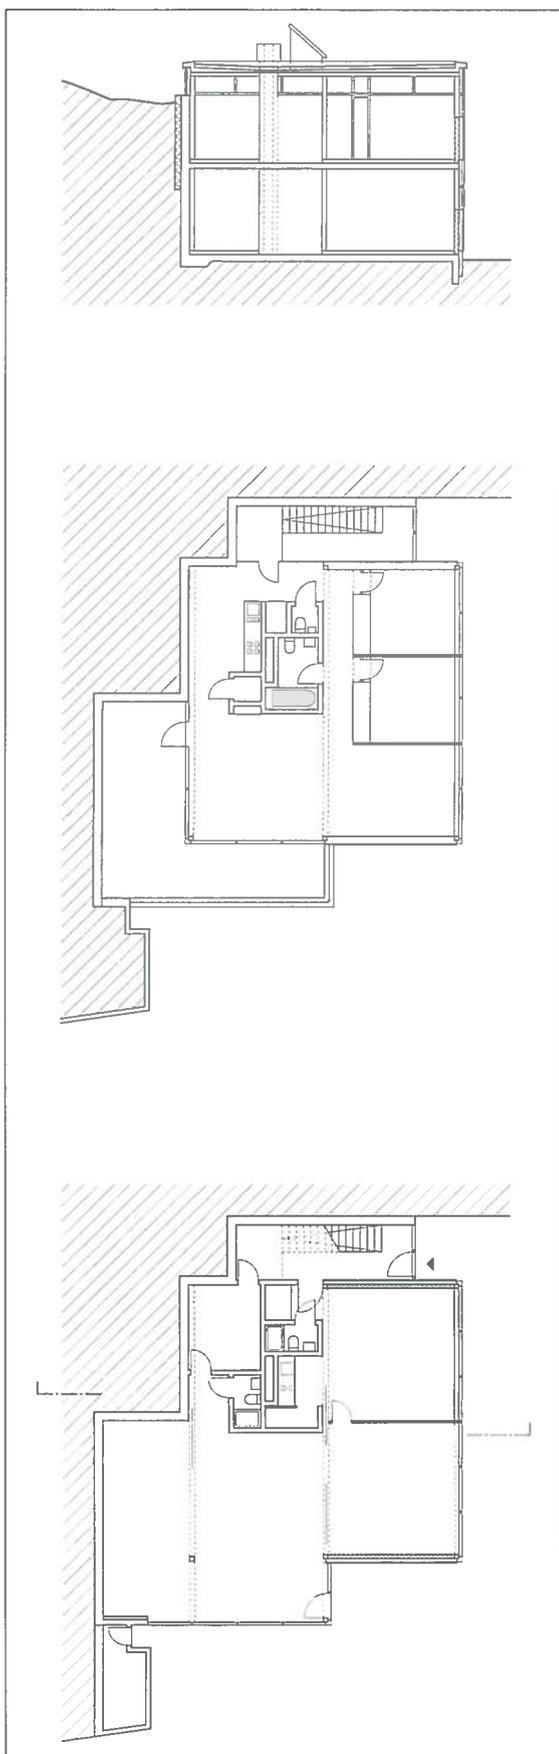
Piante del piano terra, con lo studio dell'architetto, e del primo piano con l'abitazione dell'architetto, e sezione verticale dell'edificio. Scala 1:250.
